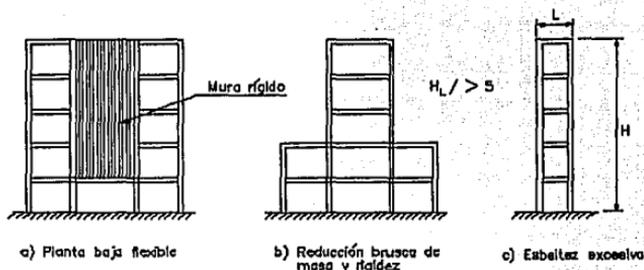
Configuraciones poco convenientes en elevación para edificios.
